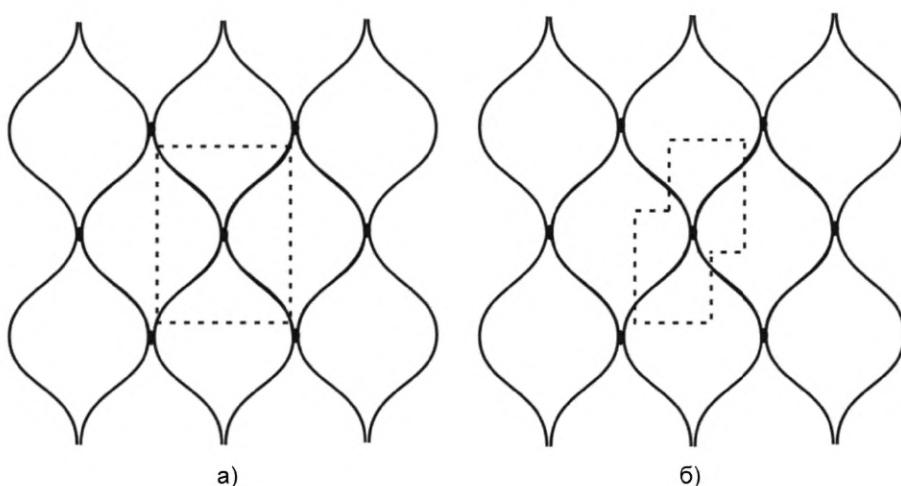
Схема подготовки образцов при испытании на отрыв (а) и сдвиг (б)
